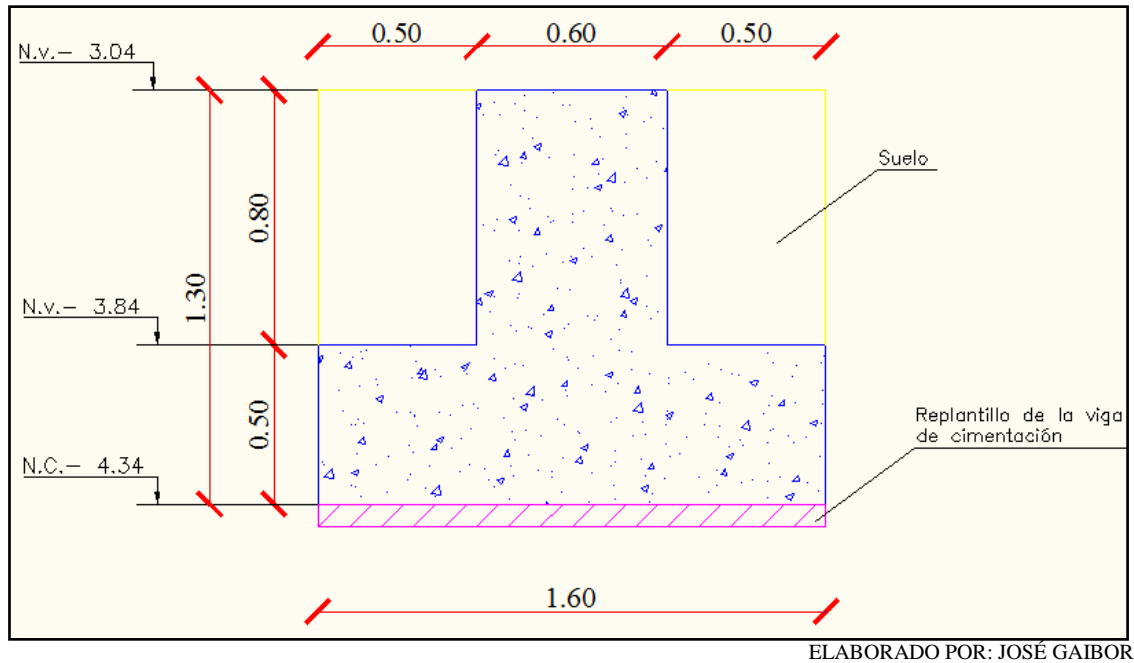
(Sección transversal de la viga de cimentación analizada)
